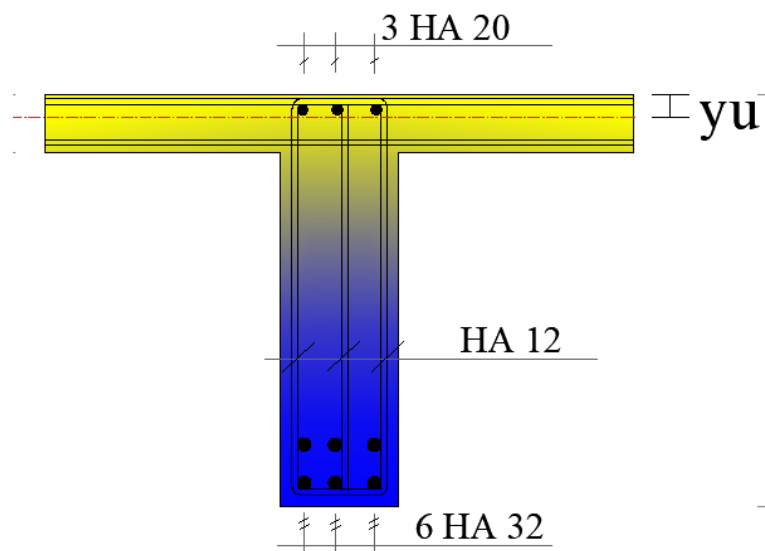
34. Section en T de l'entretoise avec plan de ferrailage (Courbon).
